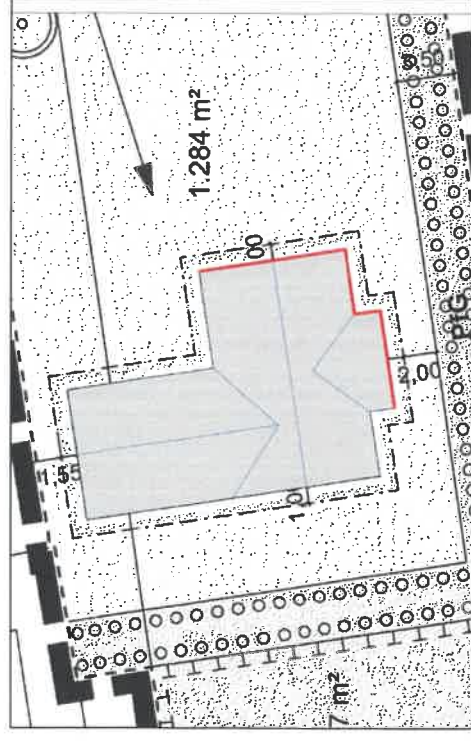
Kennzeichnung der Fassaden, an denen öffentbare Fenster unzulässig sind
